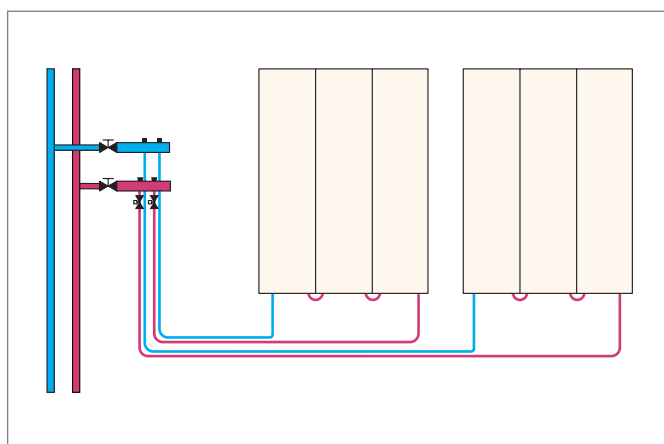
Rappresentazione schematica del collegamento in serie
